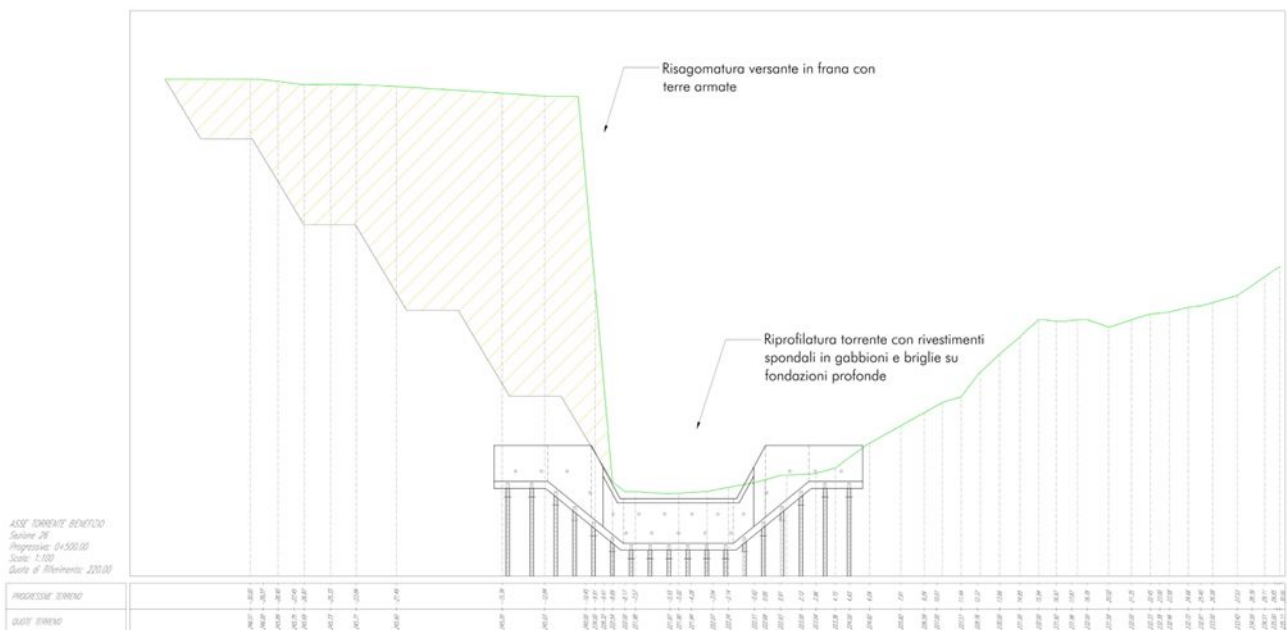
Sezione tipo con briglia su fondazioni profonde e riprofilatura del versante di monte in terre armate.
